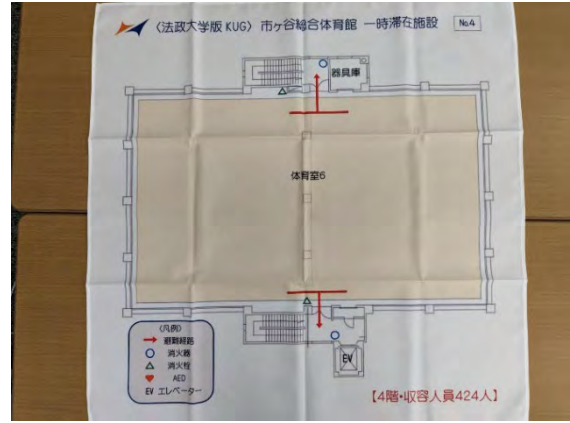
法政大学版 KUG 施設4階平面図 (縮尺 1/50)
